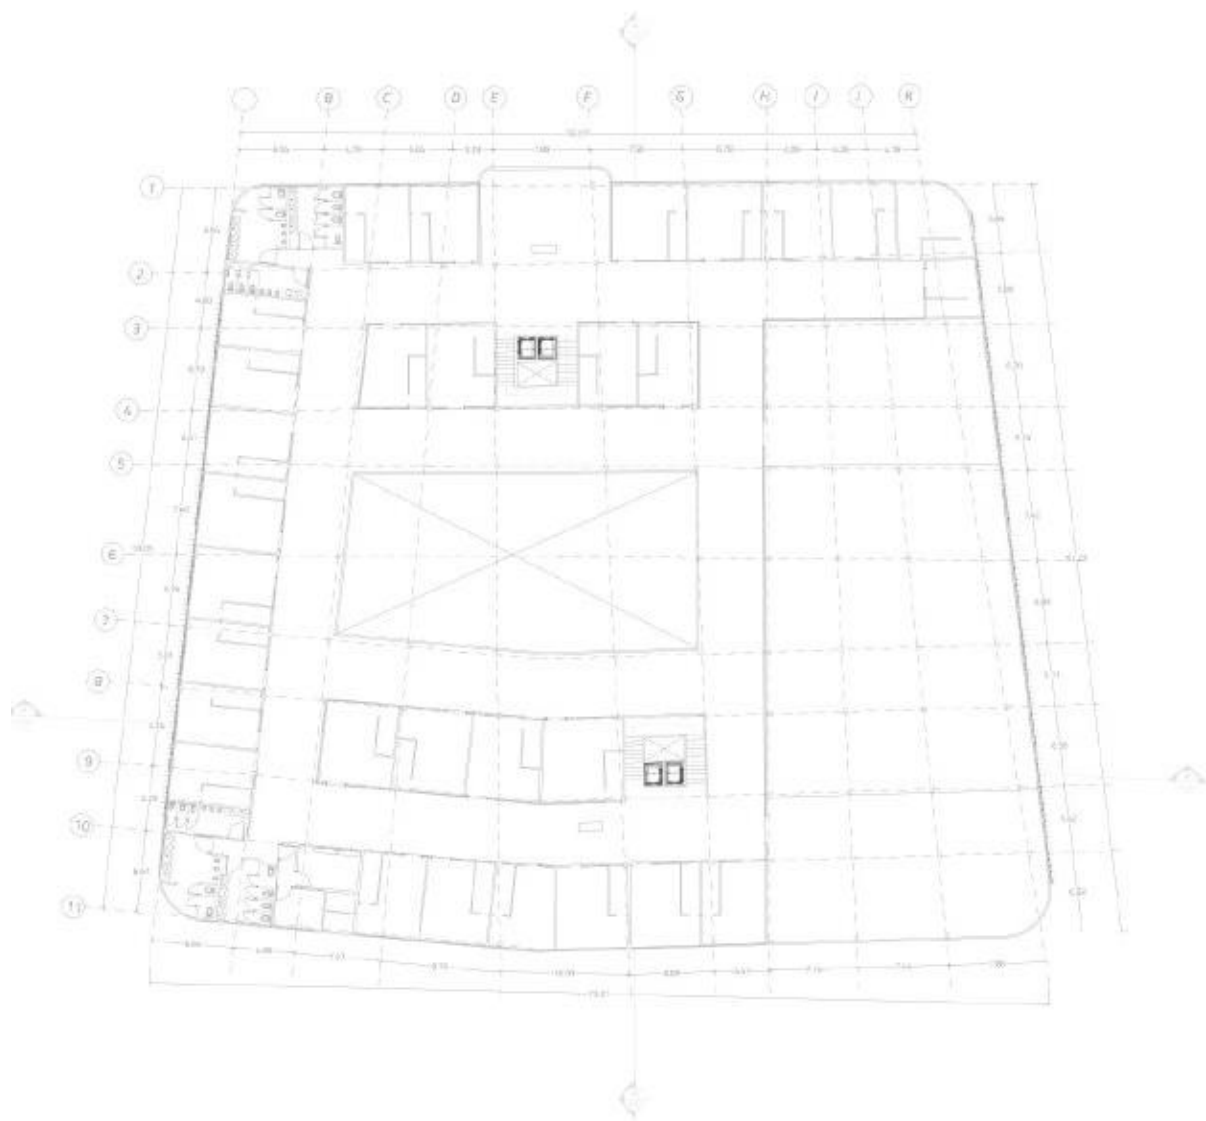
Planta segundo piso.Fuente: Elaboración propia.
